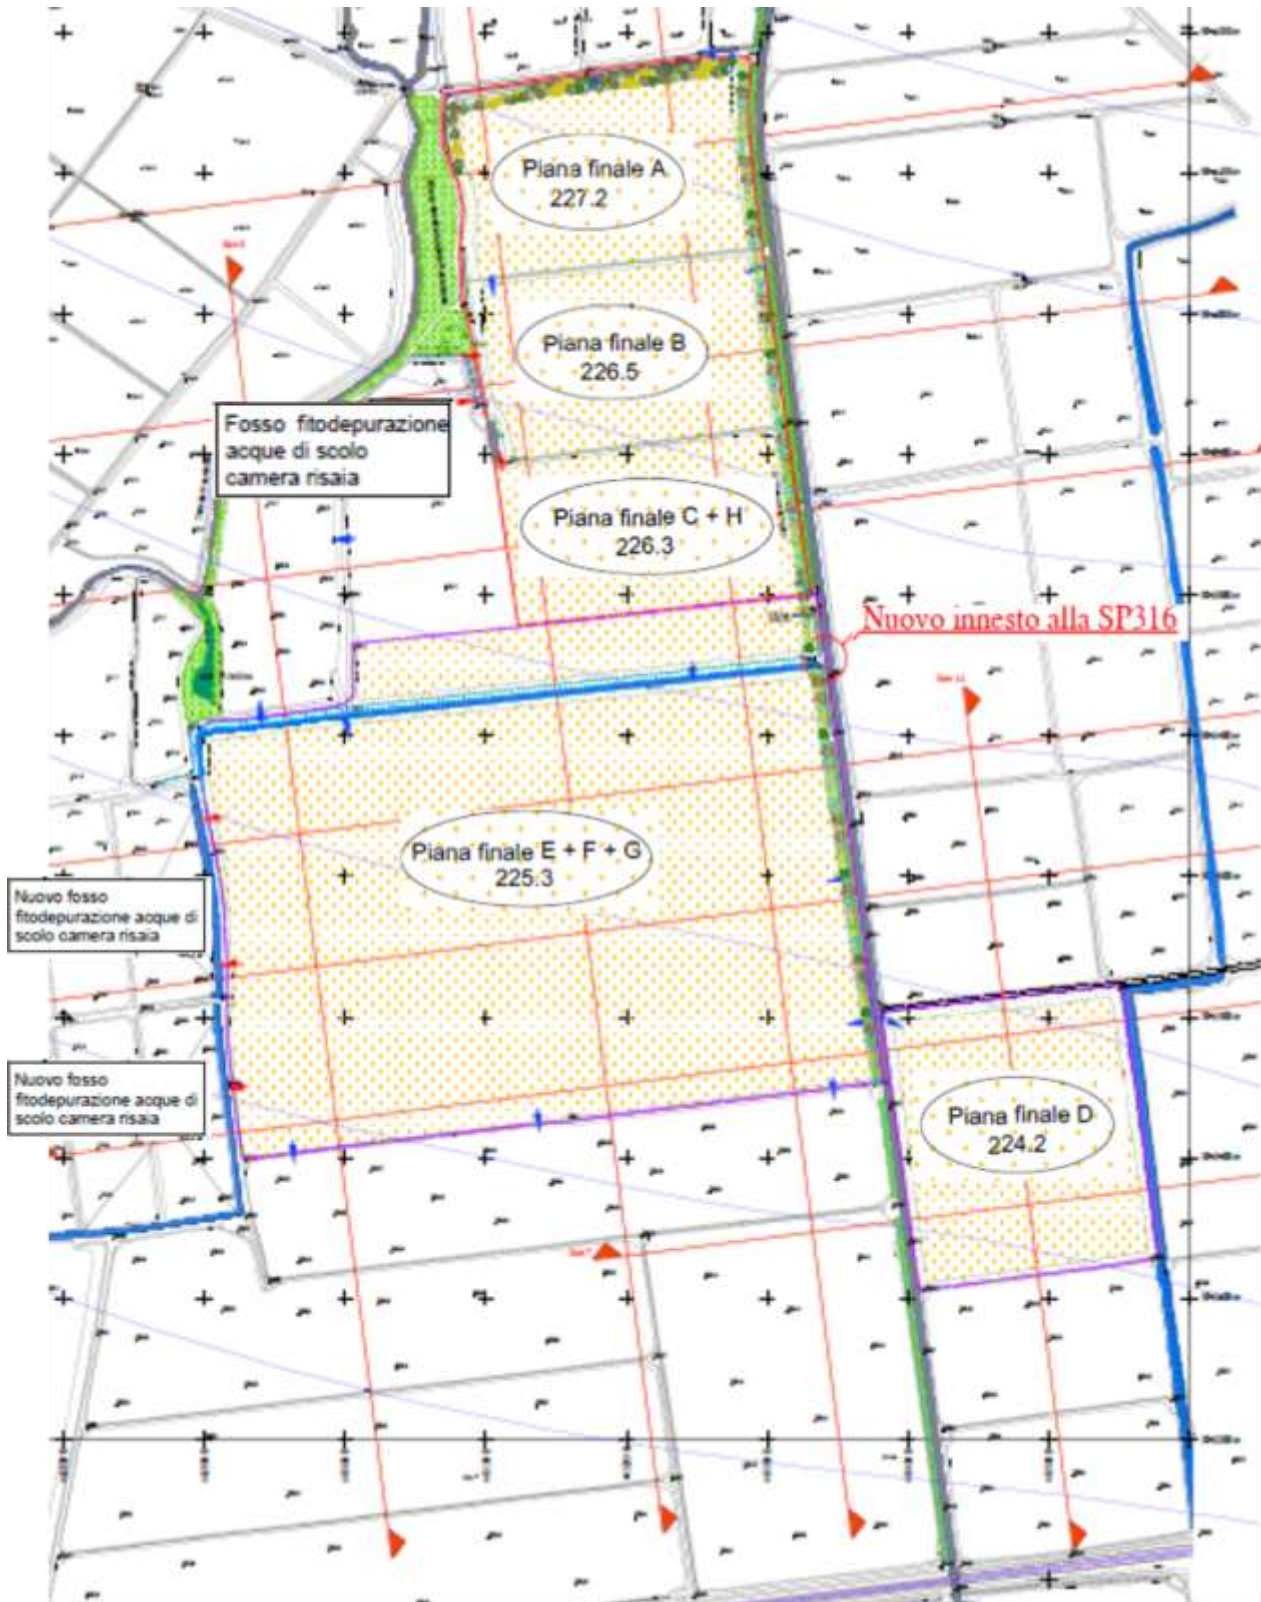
Estratto tav.05 "Planimetria situazione finale"
